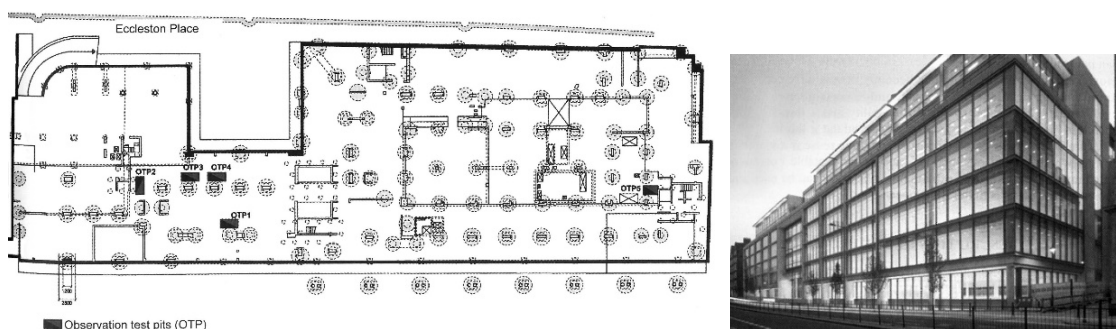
Belgrave House (Vaziri & Windle 2006a & b): Grundriss (links), Neubau (rechts)
